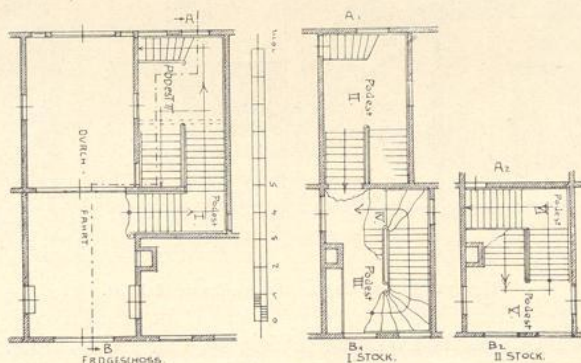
Burgstraße 25. Treppenhaus. Grundrisse.
